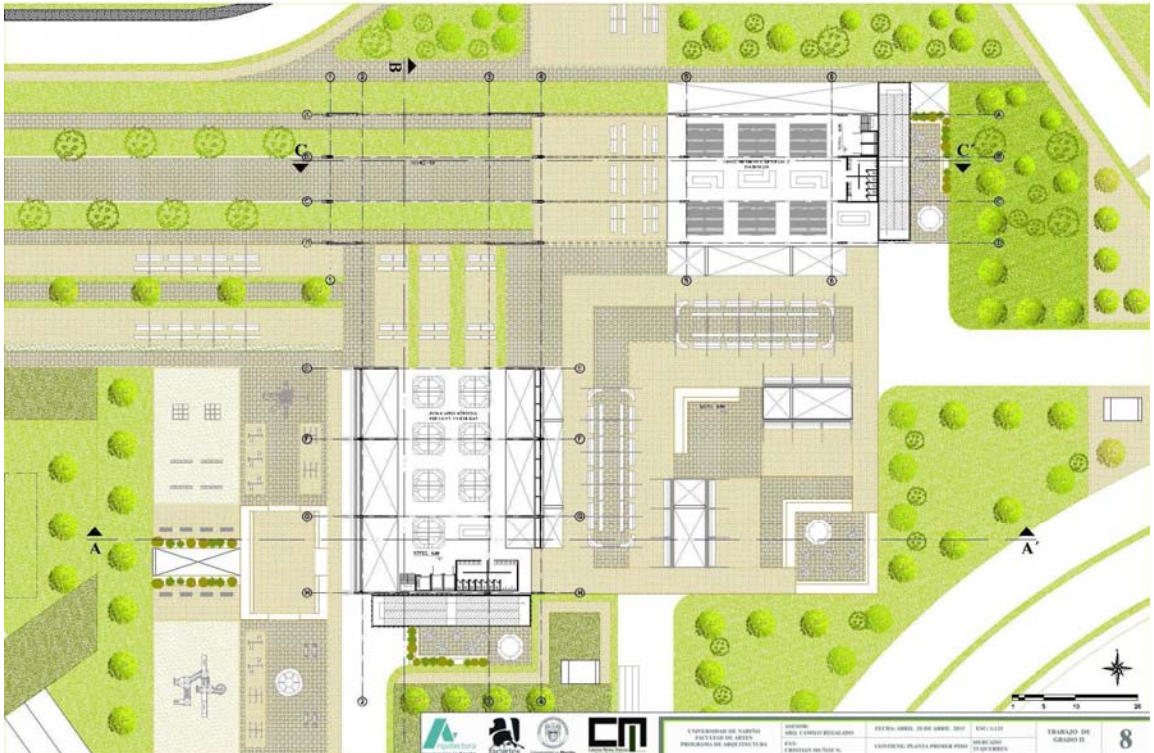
Planimetría_ planta primer piso. Fuente: elaboración propia.
